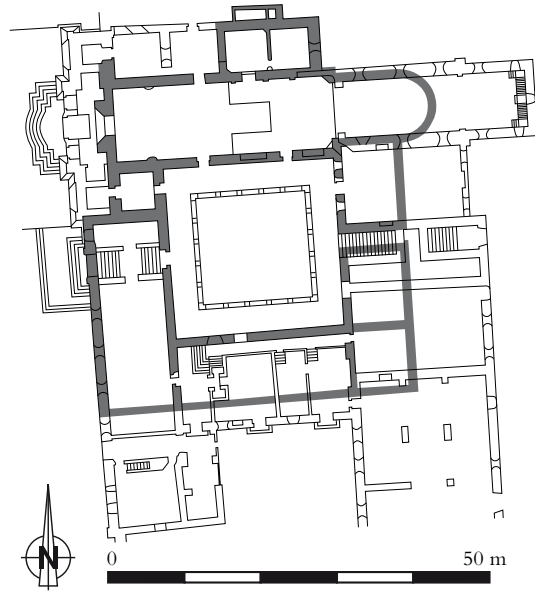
Santa Marinha da Costa : plan reconstitué des bâtiments cruziens, d'après les fouilles archéologiques. (© SIPA, DAO A. Dumontet.)
